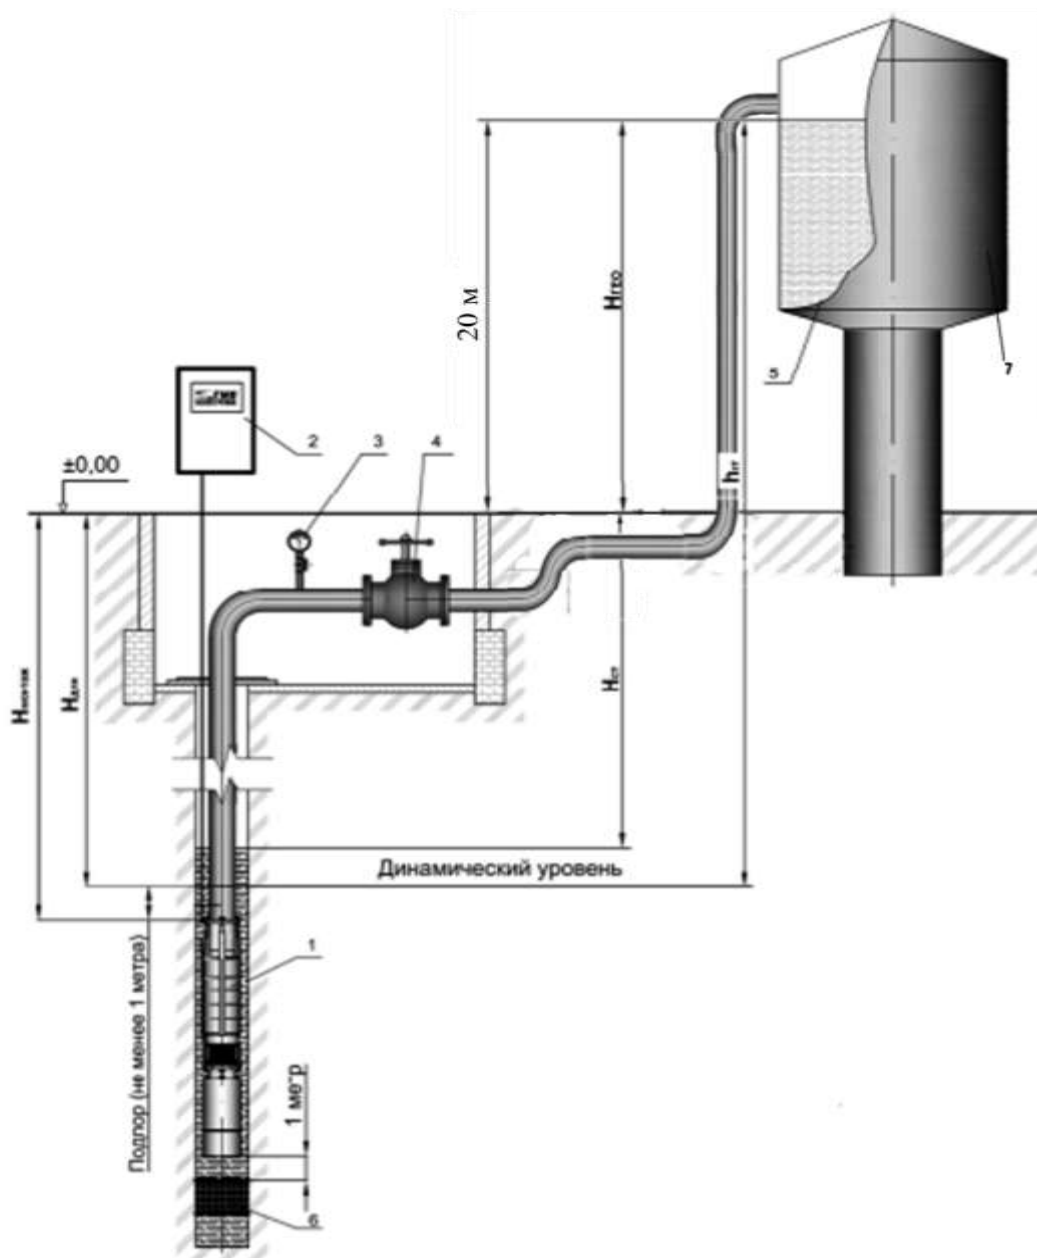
Схема скважины с трубопроводом и водоприемной башней:
